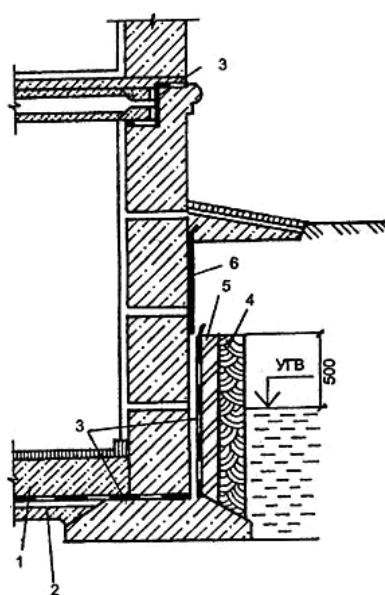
Гидроизоляция ленточного фундамента в здании с подвалом: 1 – слой нагружочного бетона; 2 – бетонная подготовка; 3 – рулонная гидроизоляция; 4 – мятая жирная глина 250 мм; 5 – кладка из кирпича-железняка на цементном растворе 120 мм; 6 – двойной слой битума
